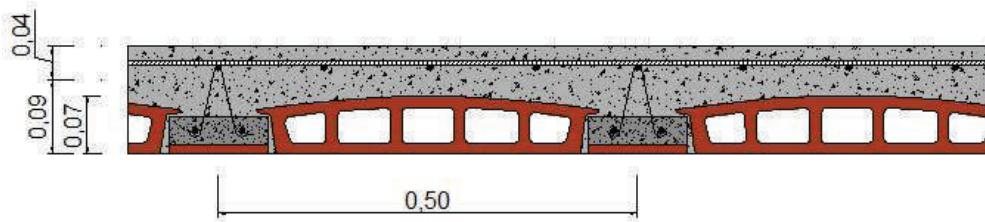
Laje com vigotas treliçadas e tavelas cerâmicas. (*)-5.
